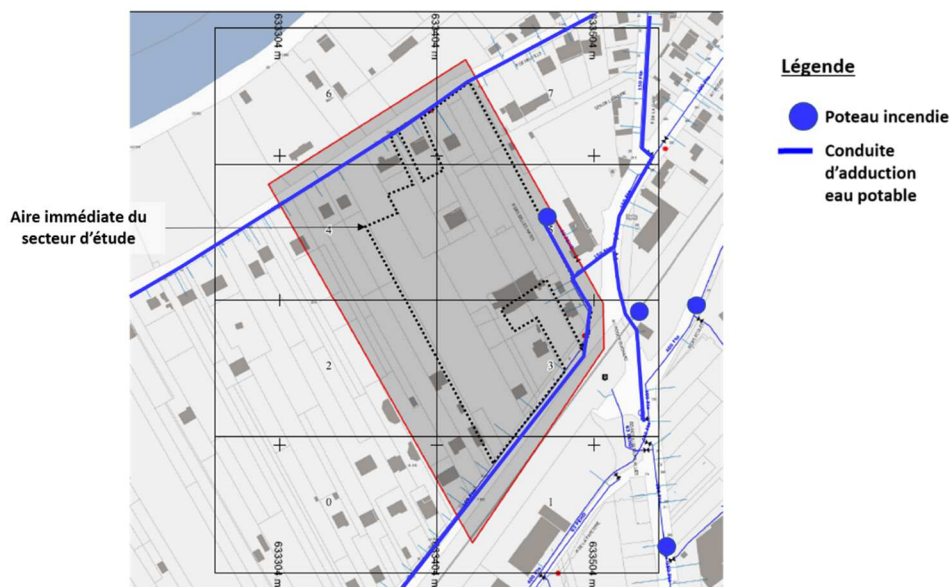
Réseau d’eau potable existant (extrait plan VEOLIA)
